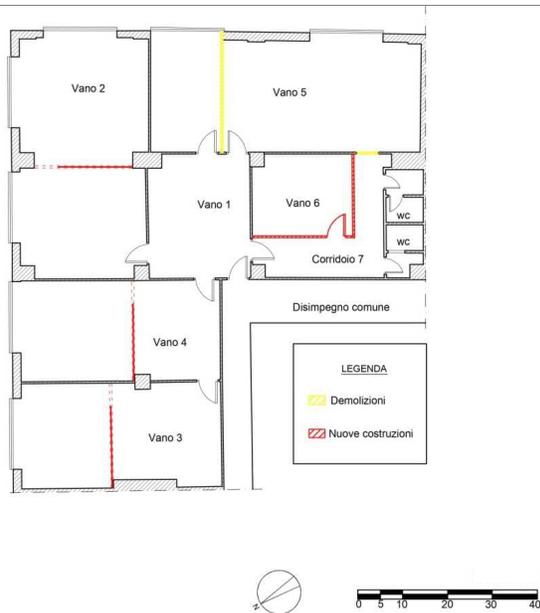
Immobile B, raffronto tra la pianta catastale e lo stato di fatto
